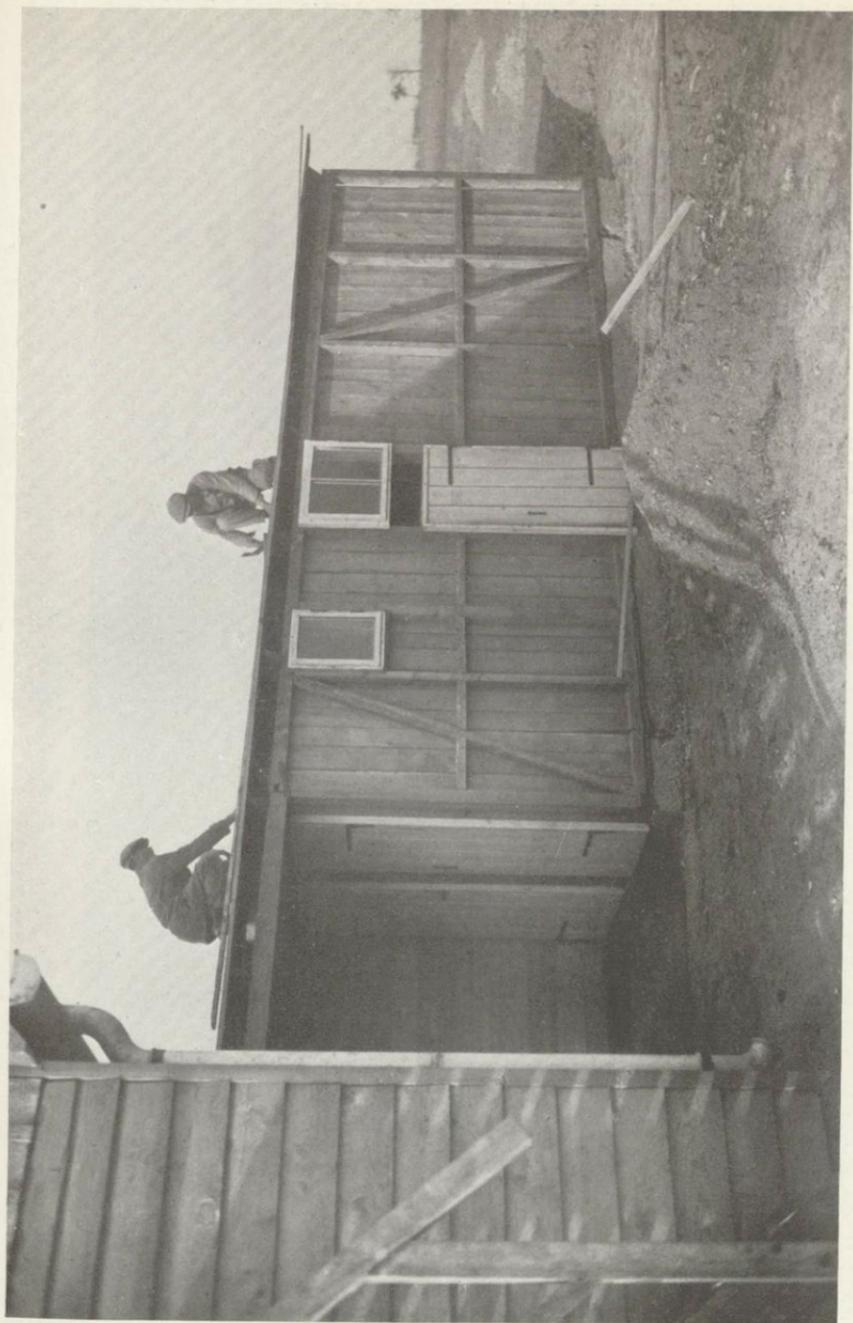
Stadtrandssiedlung Leopoldsdau-Wien: Freiwilliger Arbeitsdienst für den Siedlungsaufbau; Vollendungsarbeiten am Dach des Kleintierstalles (Außenansicht in Ergänzung zu Abb. 13 und 14)
